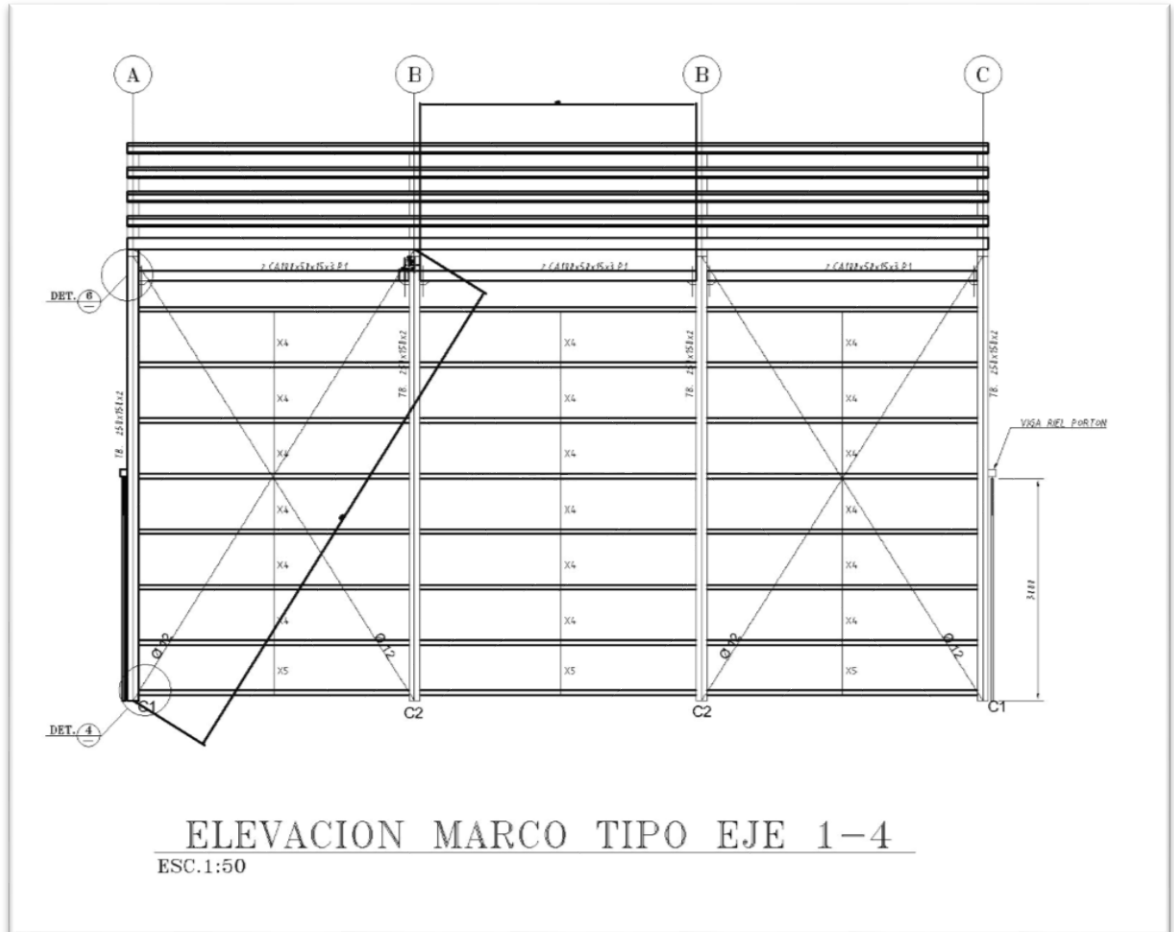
3: Planta elevaciones eje 1-4 nave 12x9 para almacenamiento de materiales
